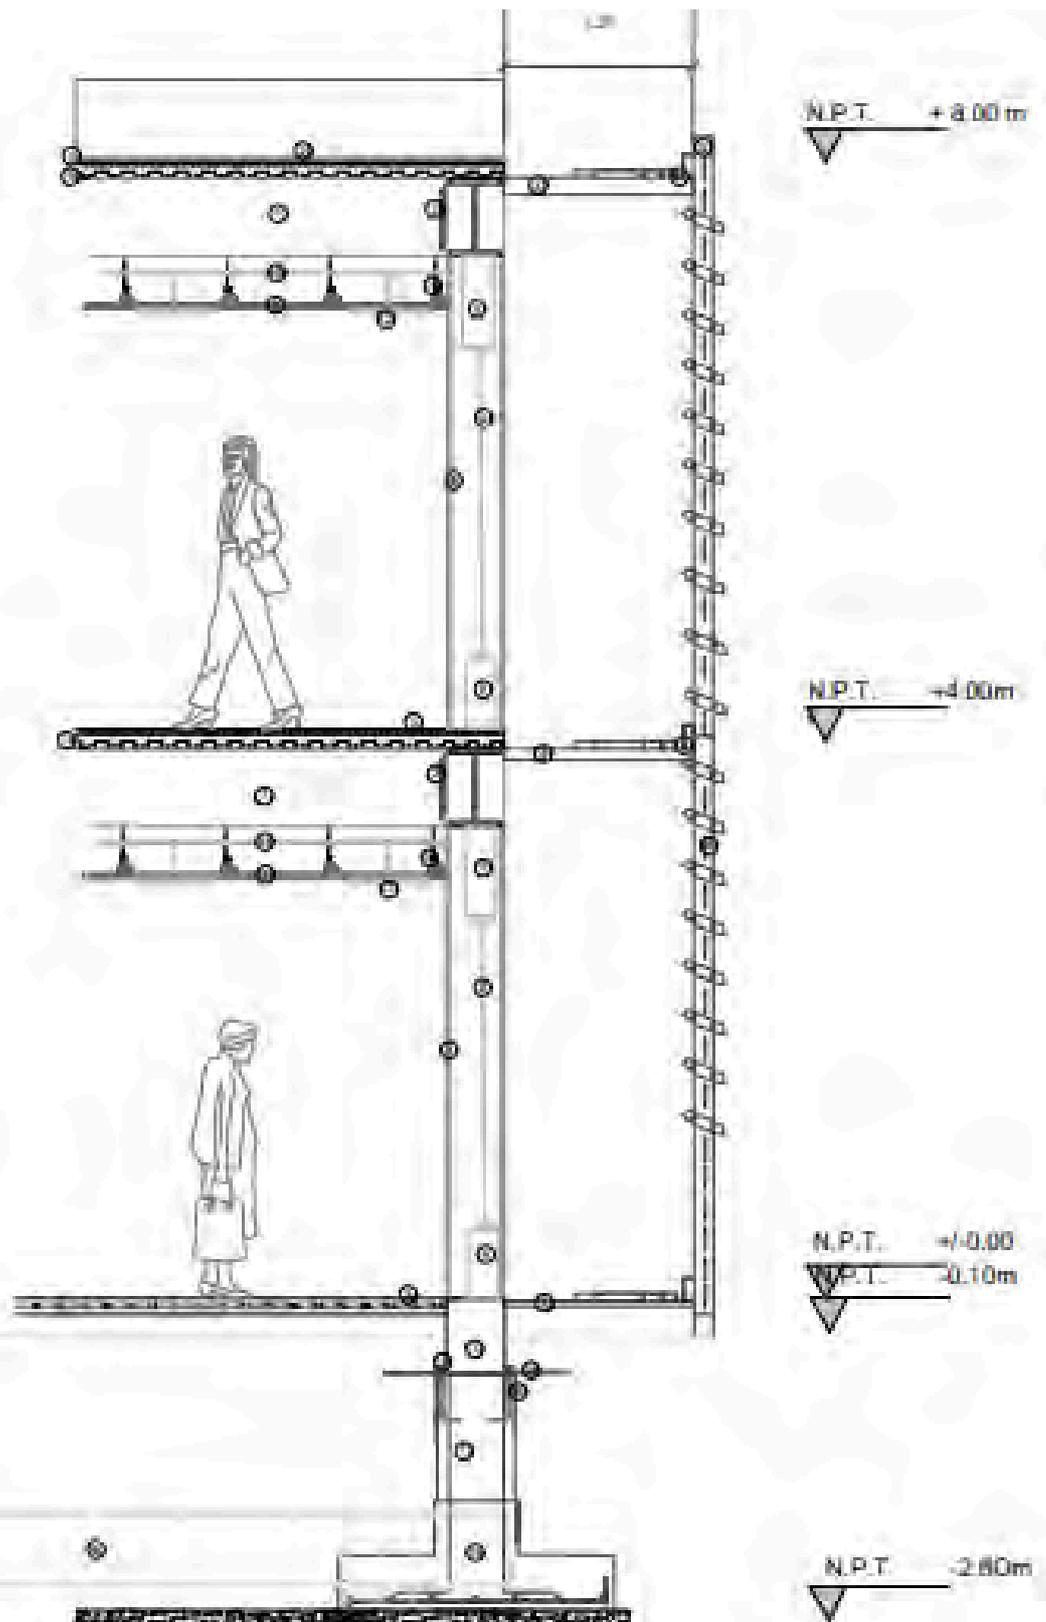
Corte por fachada del edificio principal. Elaboración propia.
